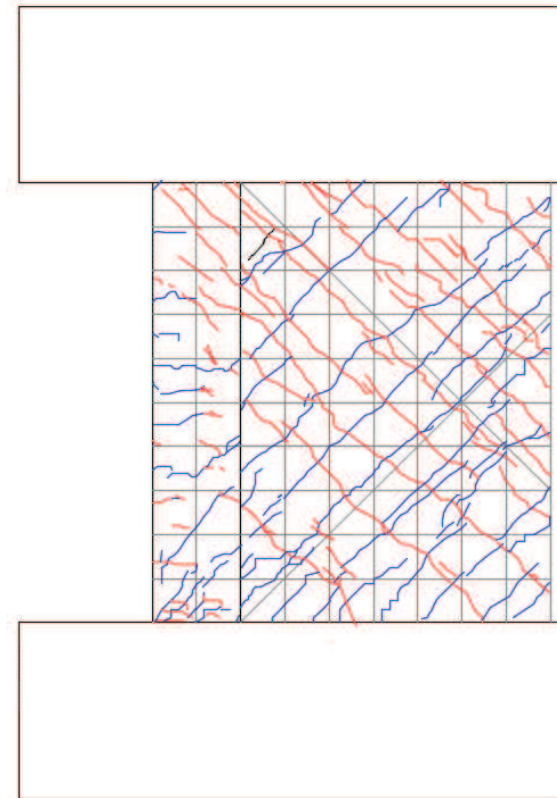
試験体 S-06-DIII 事前加力終了時 (4/1000rad.) ひび割れ図
